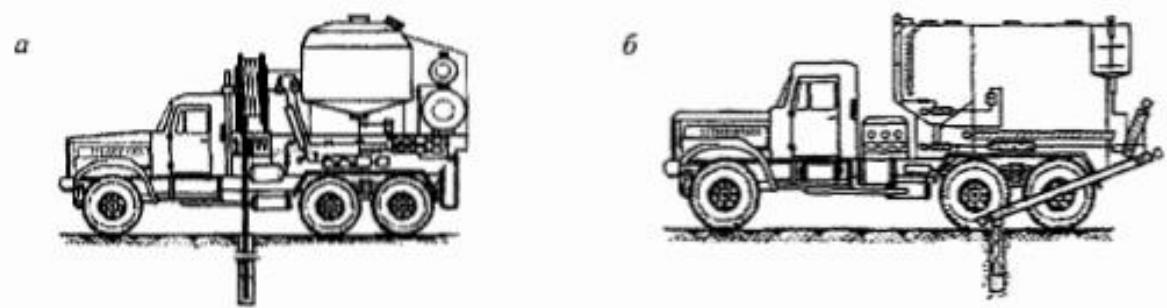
Машины для приготовления и зарядки порэмита
